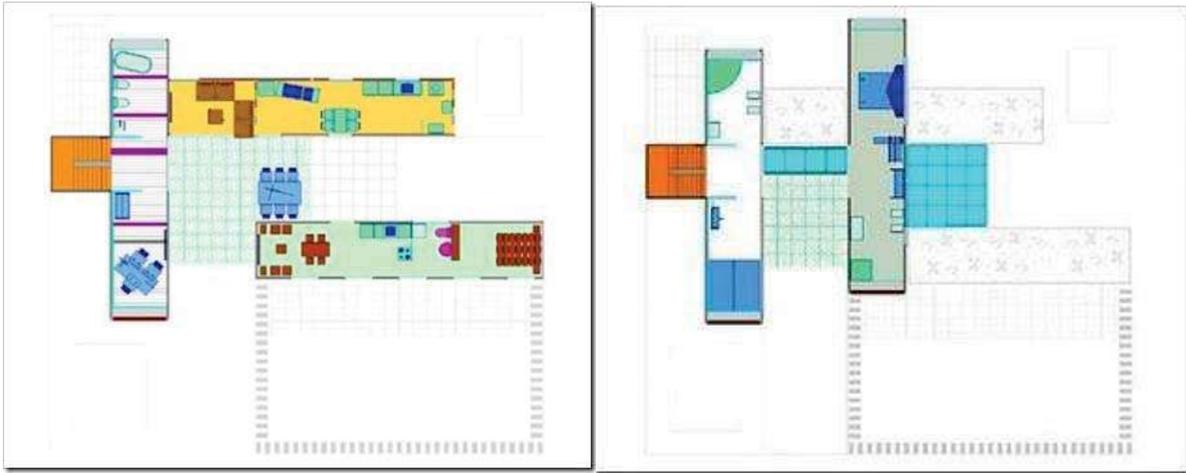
Planta baja y alta. Fuente. <http://lasfachadas.blogspot.com/2010/08/casas-ecologicas-sostenibles-r4-house.html>.
